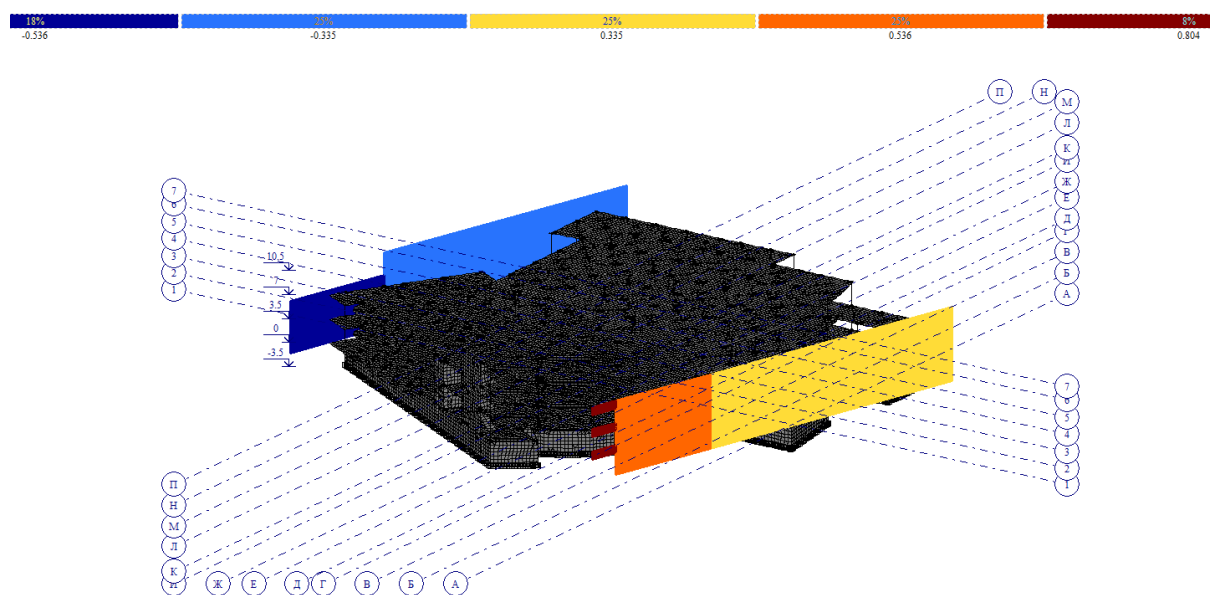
Ветровые нагрузки по оси X на боковые стены
